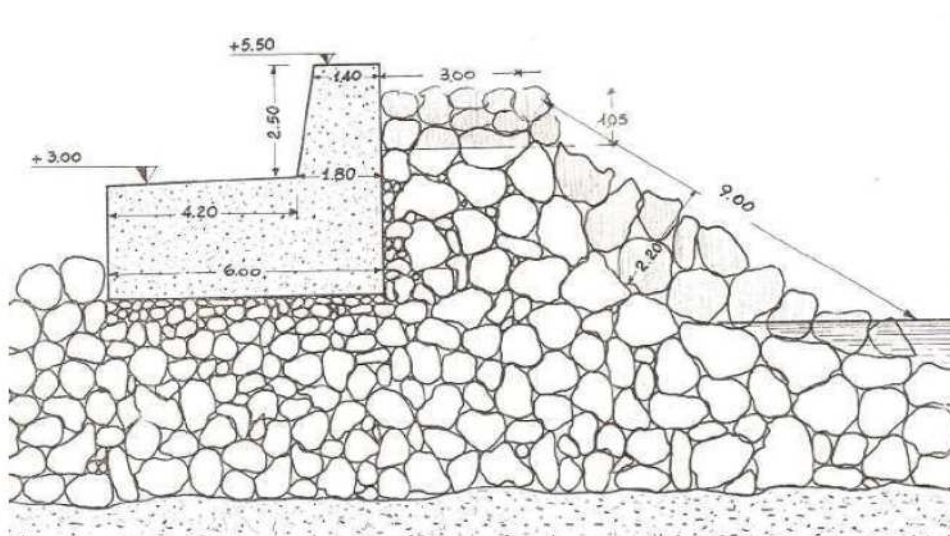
Sezione del molo di sopraflutto (fonte archivio STRUPORT)
